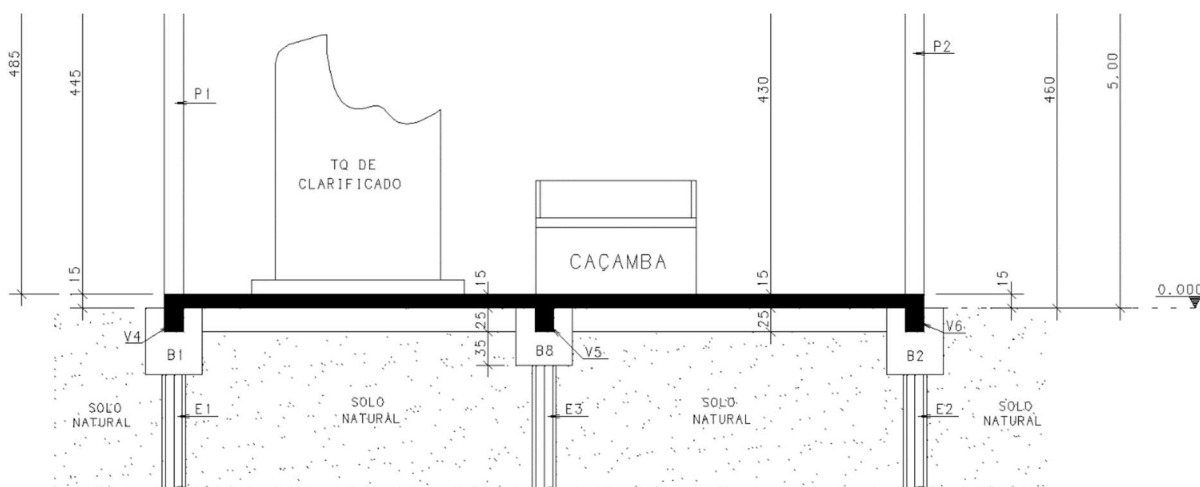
Detalhe em Corte da Fundação (blocos, estacas e vigas).
